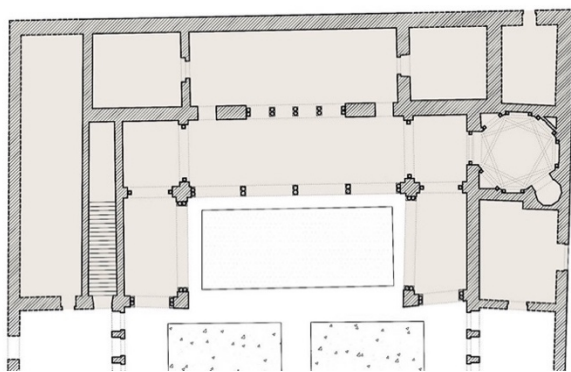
Planta del palacio taifa de la Aljafería (Zaragoza) con el esquema de sala y alhanías duplicado.
